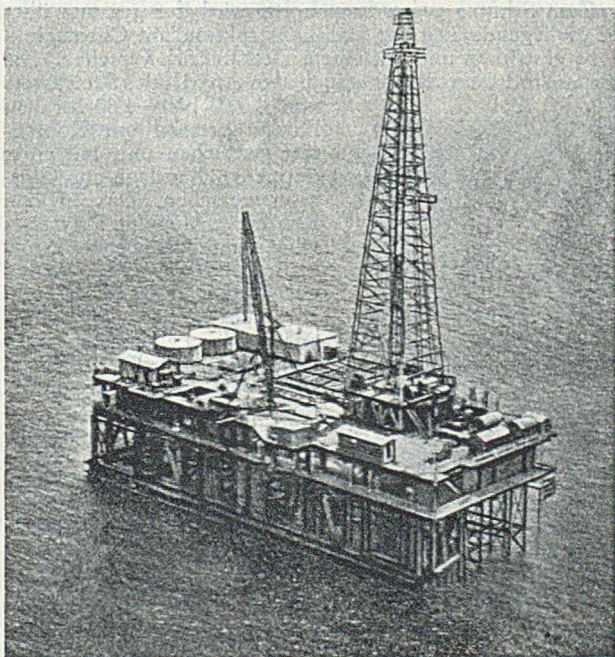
Künstliche Insel, 63,0×33,5 m groß, auf 85 m langen Stahlpfählen, Doppeldeck.
